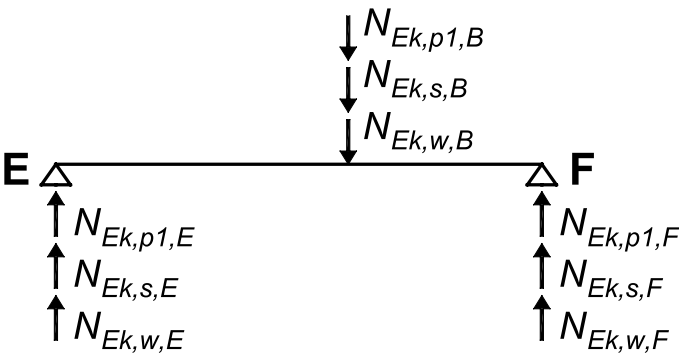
Schemat statyczny wycinka więźby dachowej
